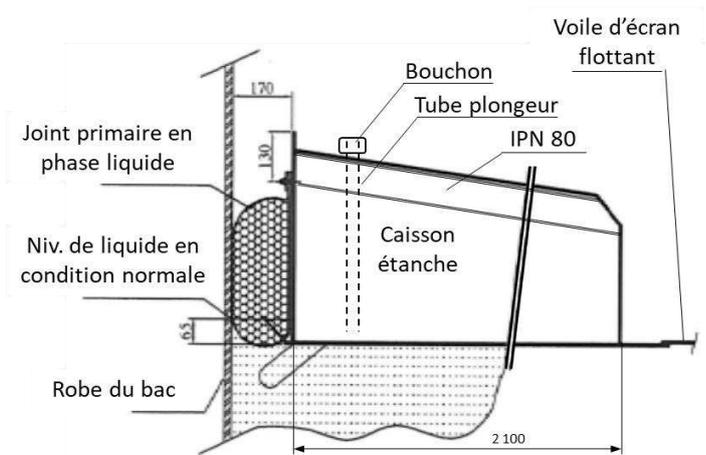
Schéma d'un caisson étanche – vue en coupe
